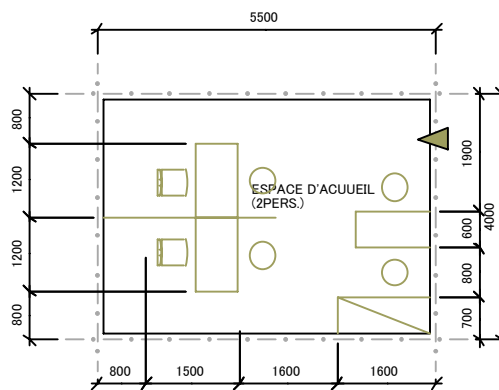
Plan planimétrique du bureau des techniciens de la fabrication de glace
